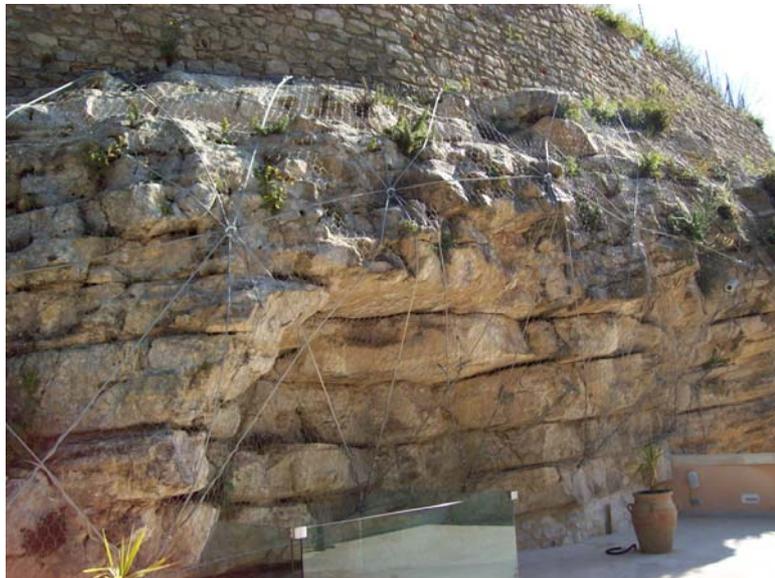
Particolare del dissesto n. 082-7RA-053 interessato dalle opere di consolidamento
